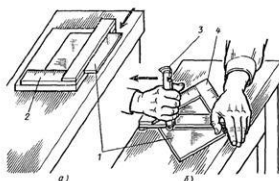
Резка керамических плиток с помощью приспособлений для прямой резки по размеру (а) и для резки под углом (б):
